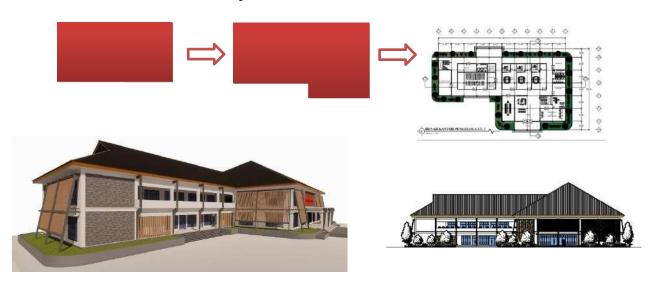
Tampilan Bangunan Fasilitas Pengolahan Sampah.
